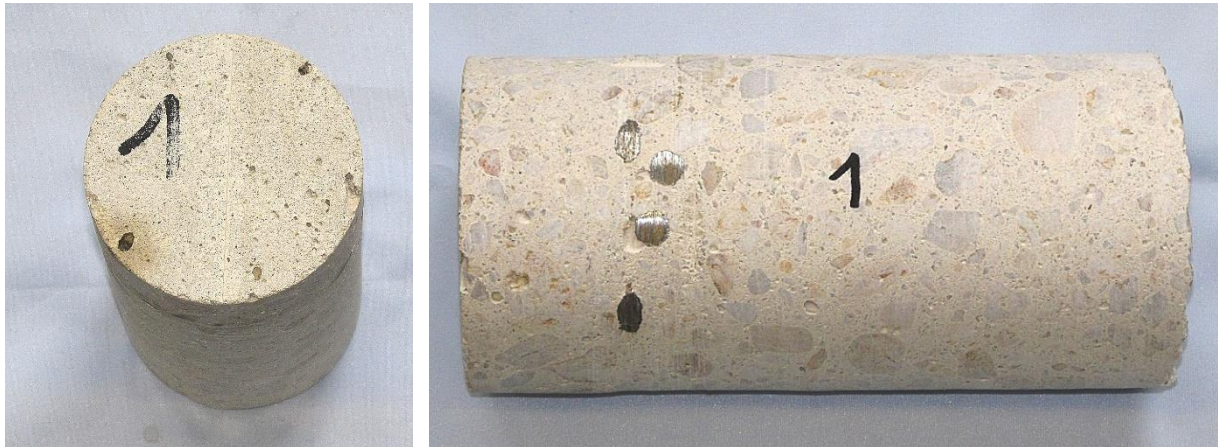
Bohrkern 1, entnommen aus einer Ortbetonwand der Nordfassade, Stirn- und Seitensicht (außenseitige Wandoberfläche links)
